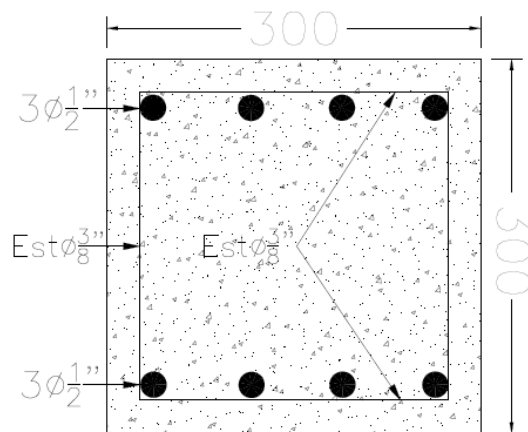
Corte transversal refuerzo viga. (Fuente: Elaboración propia)
